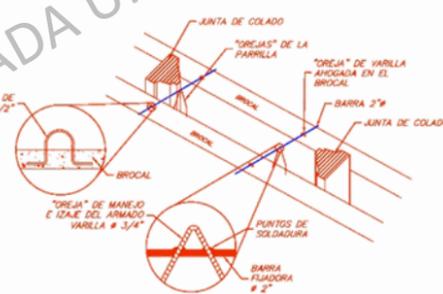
"OREJAS" DE FIJACION DEL ACERO DE REFUERZO
